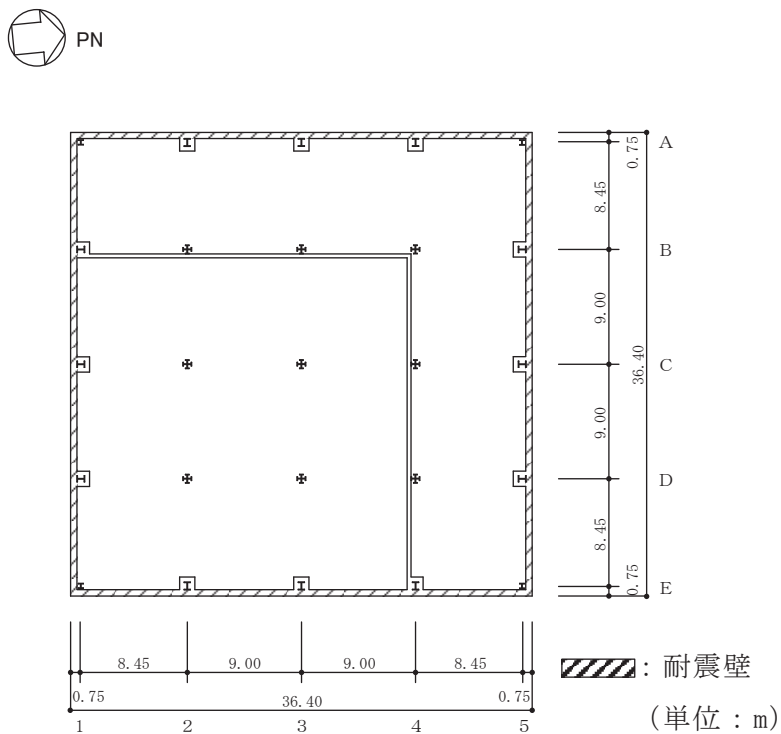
(4) 耐震壁の評価を記載する部材の位置 (2F, O.P.69.4m)
